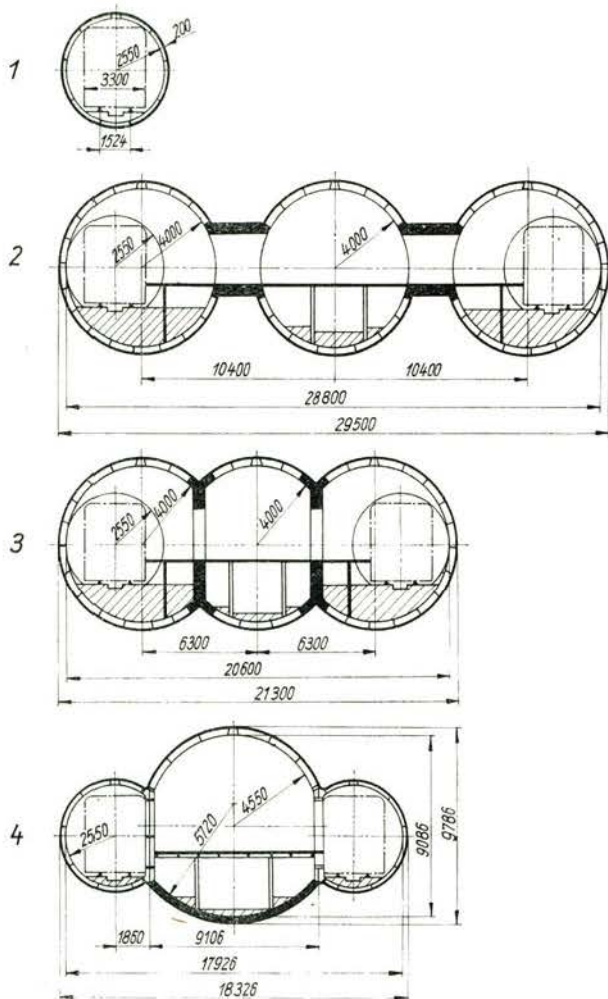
Querschnitte der Metro bei Bauweise in Tiefelage (Maßangaben sind Richtwerte). 1. freie Strecke mit Stahlbeton-Kassettenübbings, 2. Haltestelle mit Pylon-Säulen, 3. Haltestelle mit Kolonnen-Säulen, 4. Haltestelle mit türverschlussnem Bahnsteig
